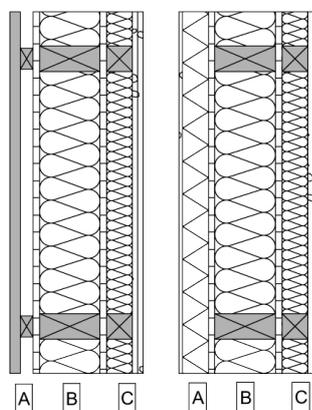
Systembereiche: A) Fassade; B) Kernelement; C) Installationsebene (Eigene Darstellung)
